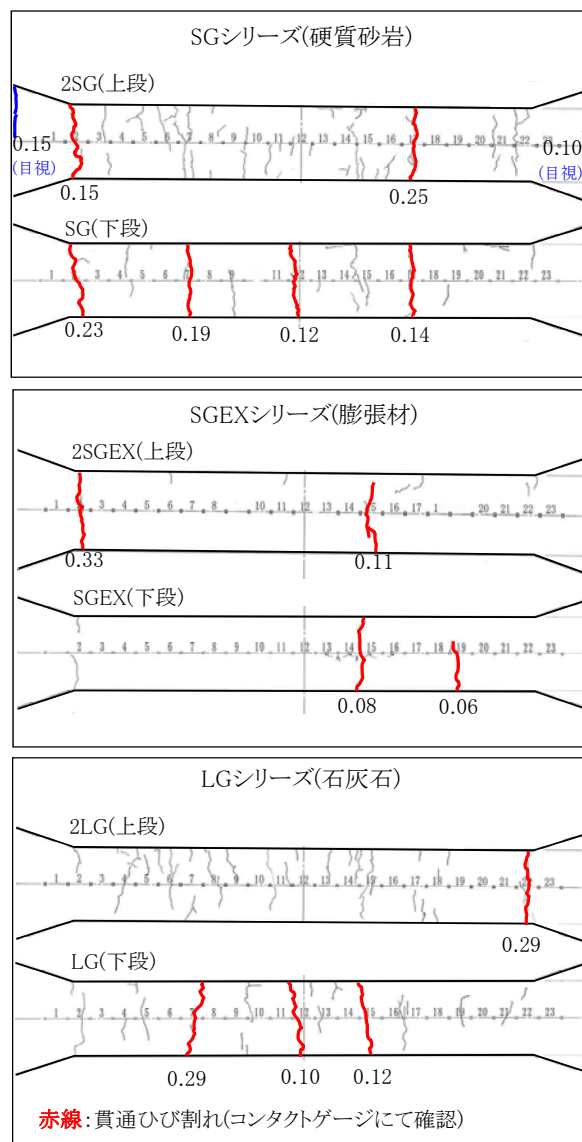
ひび割れ発生状況(門形フレーム試験体)
